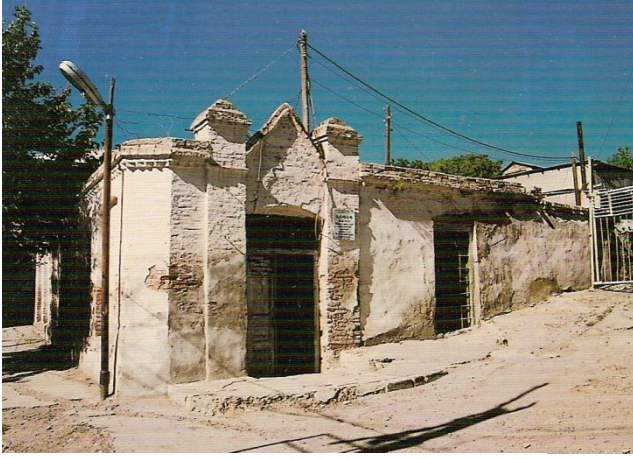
Ordubad hamamı. Hamamın bərpadan öncə görünüşü və planı
